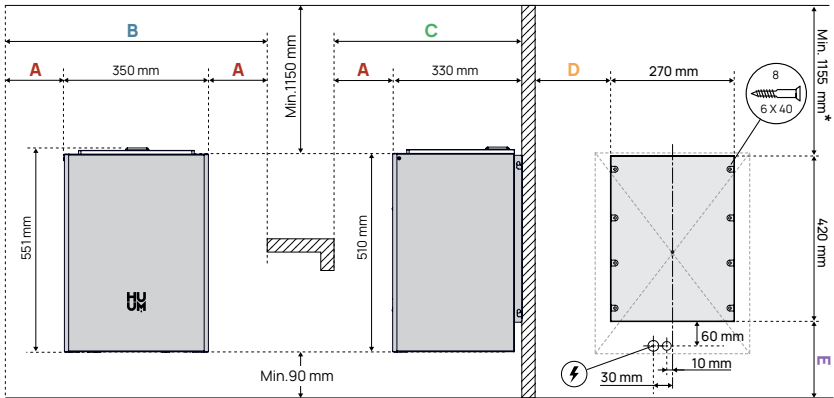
HUUM CORE Wall Combi -kiukaan sijoittaminen.
